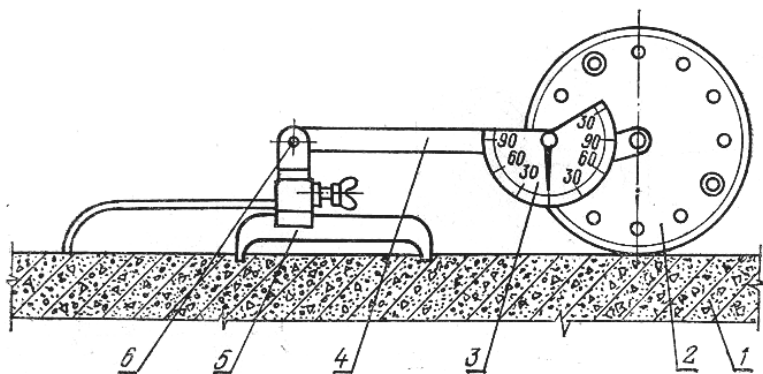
Маятниковый прибор ДПГ-4: 1 – поверхность бетона испытываемой конструкции; 2 – диск с ударной кромкой; 3 – угломерная шкала; 4 – плечо; 5 – опора; 6 – ось вращения плеча с диском
